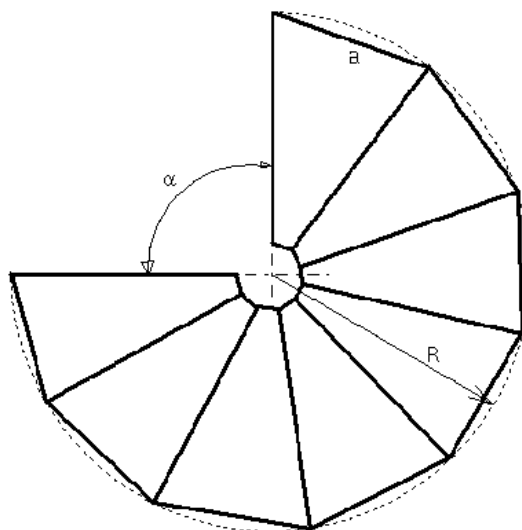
Схема бетонирования (на полу) покрытия в виде усеченной пирамиды
